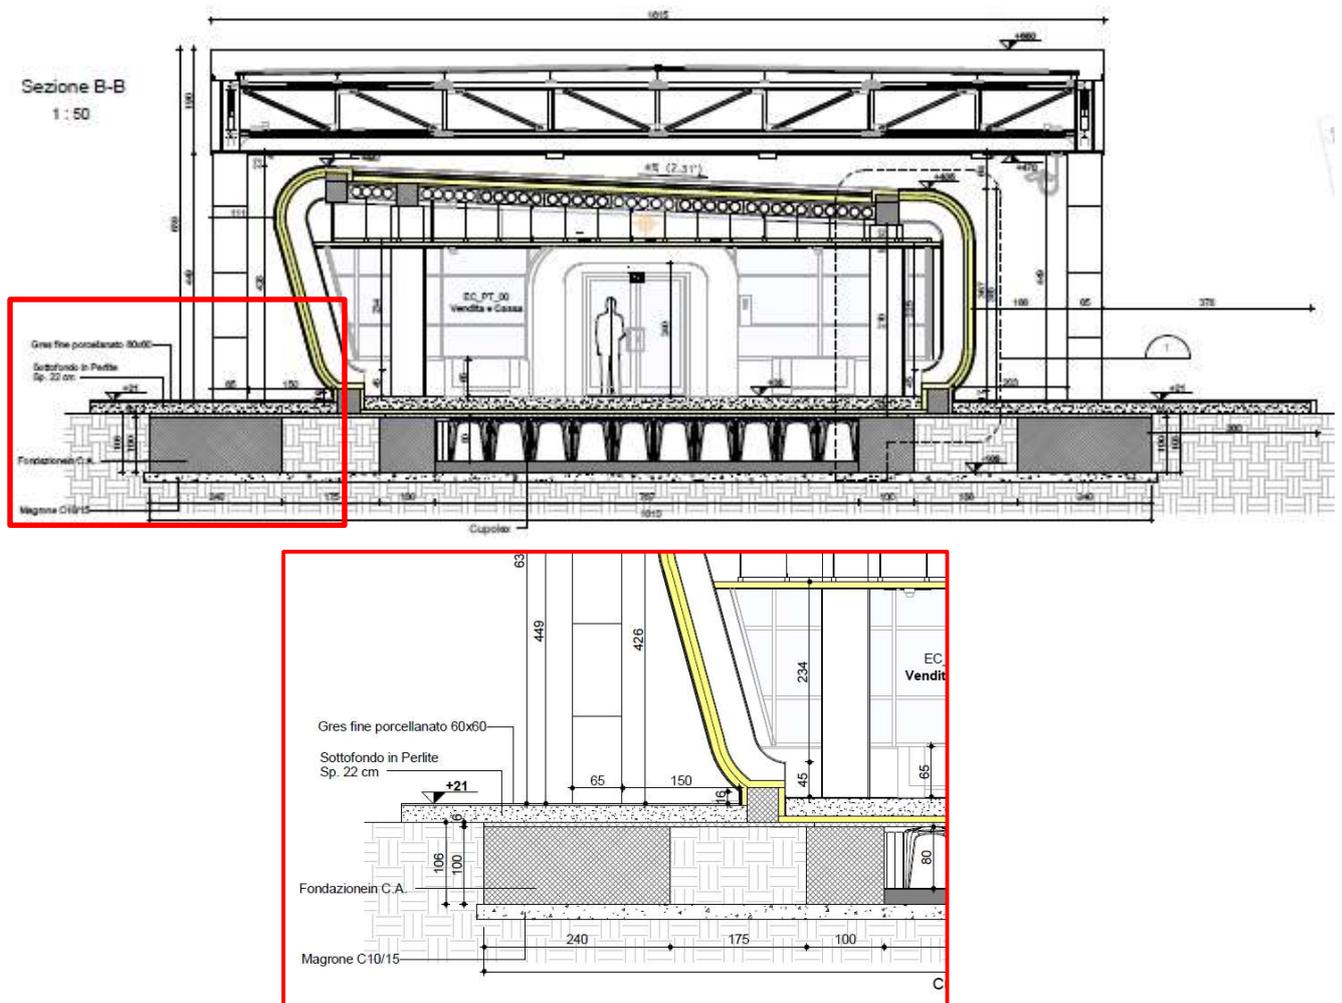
CEC – sezione longitudinale e dettaglio fondamenta
